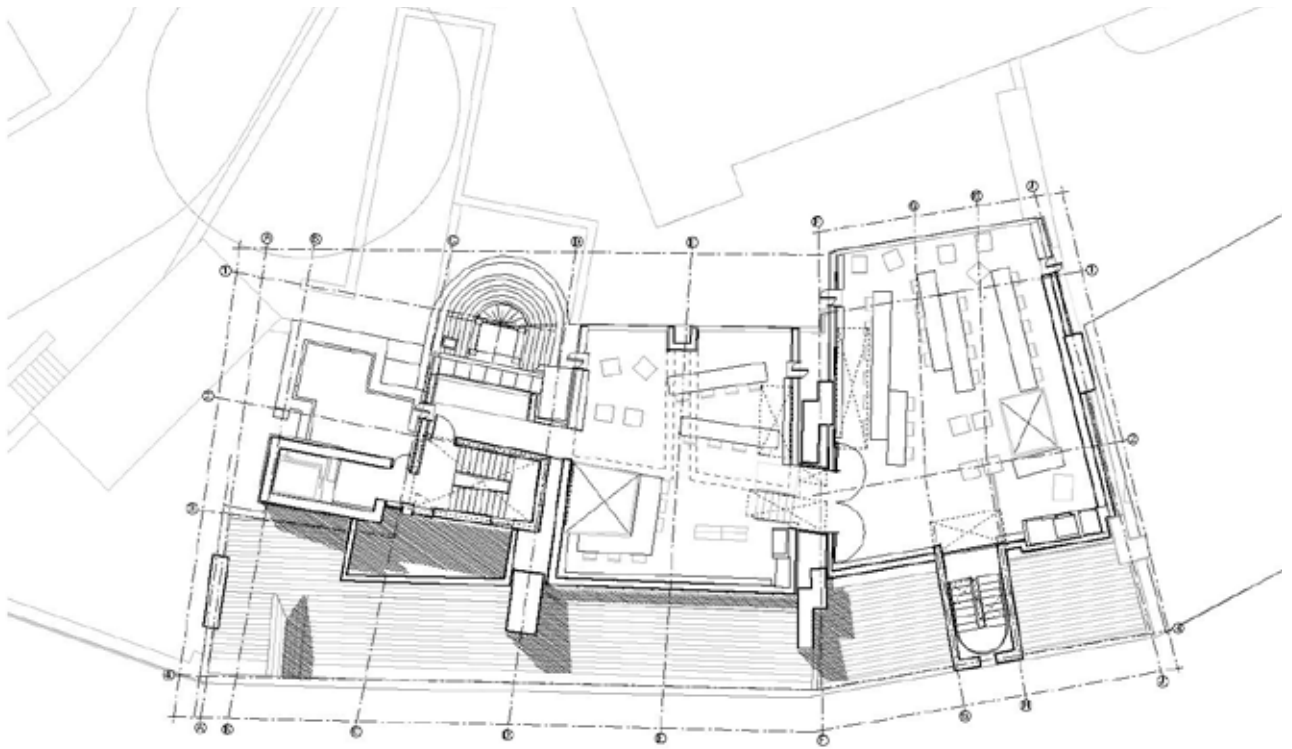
Grundriss © McCollough Mulvin Architects
